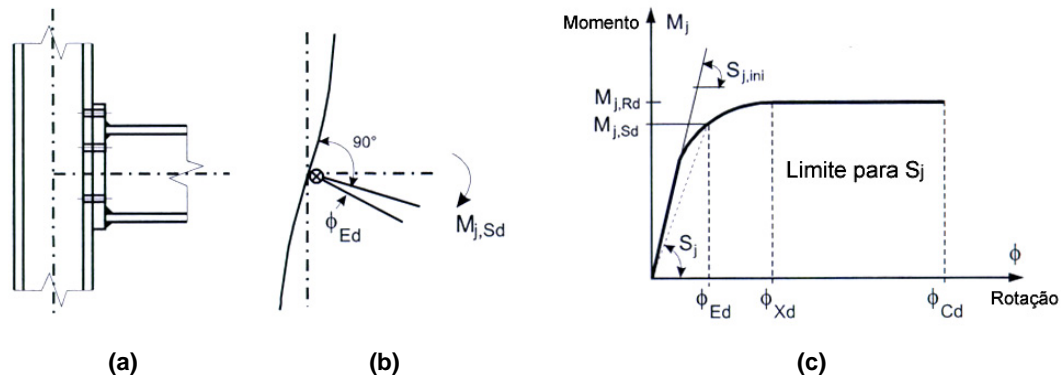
Caracterização de uma ligação viga-coluna [7,6]
